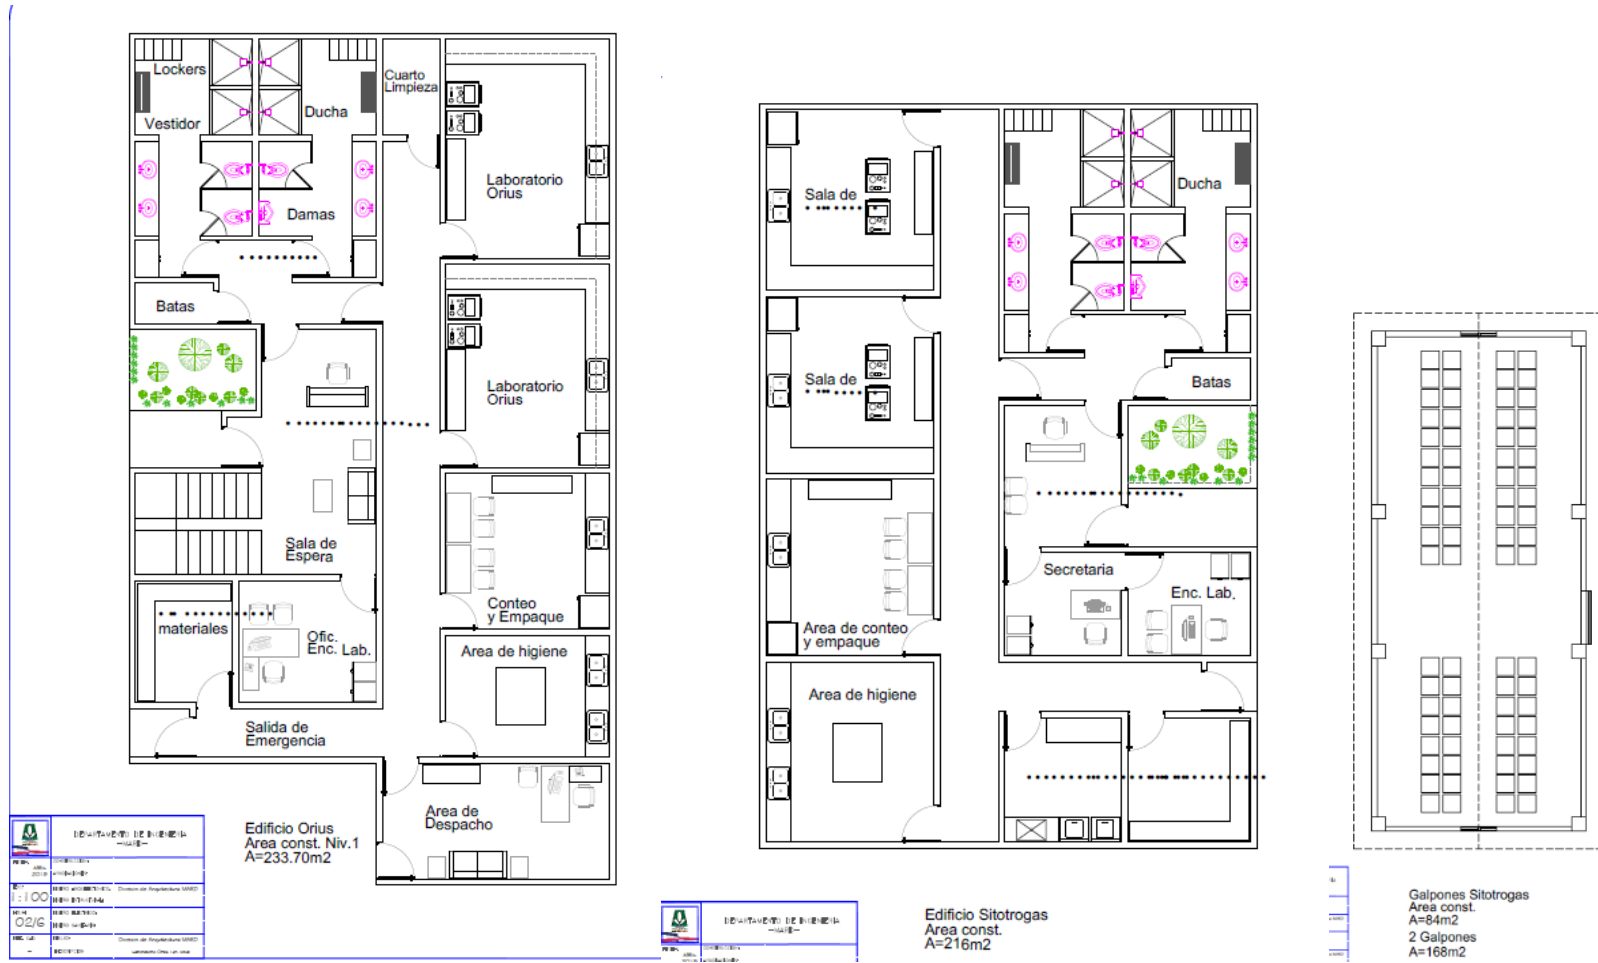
Planos del laboratorio de control biológico previsto en La Vega primera planta del edificio Orius; edificio sitotrogas y área de galpones (Dirección de ingeniería del MA, 2019)
